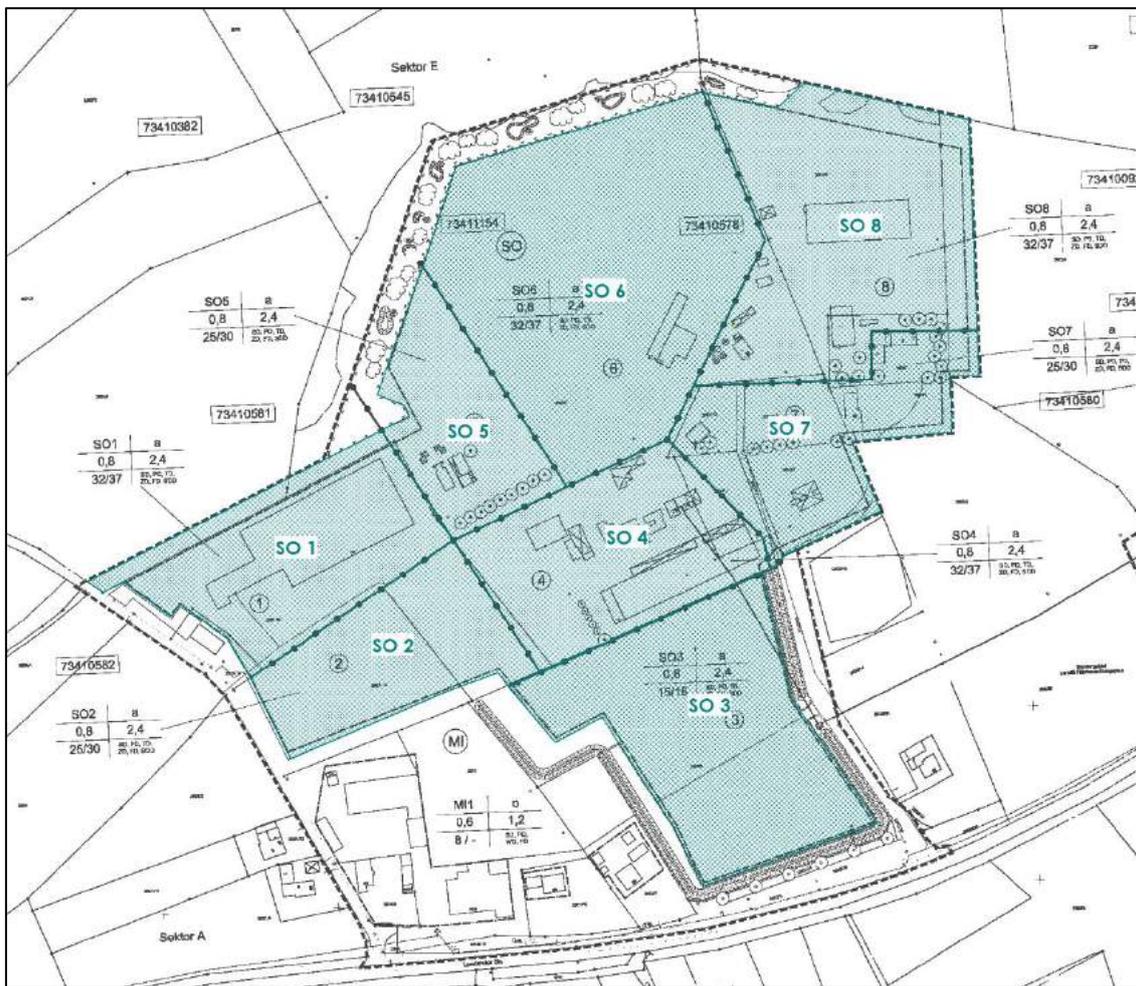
Lageplan mit Darstellung der relevanten Kontingentflächen
